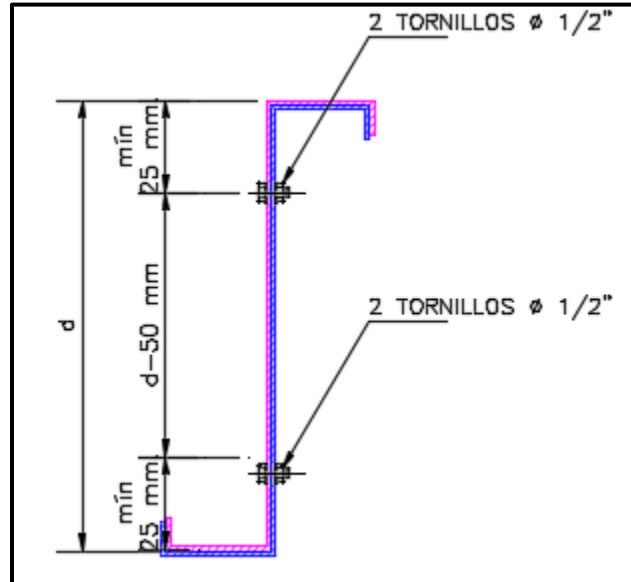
Traslape de perfiles ZF, vista transversal (autoría propia, 2021).
